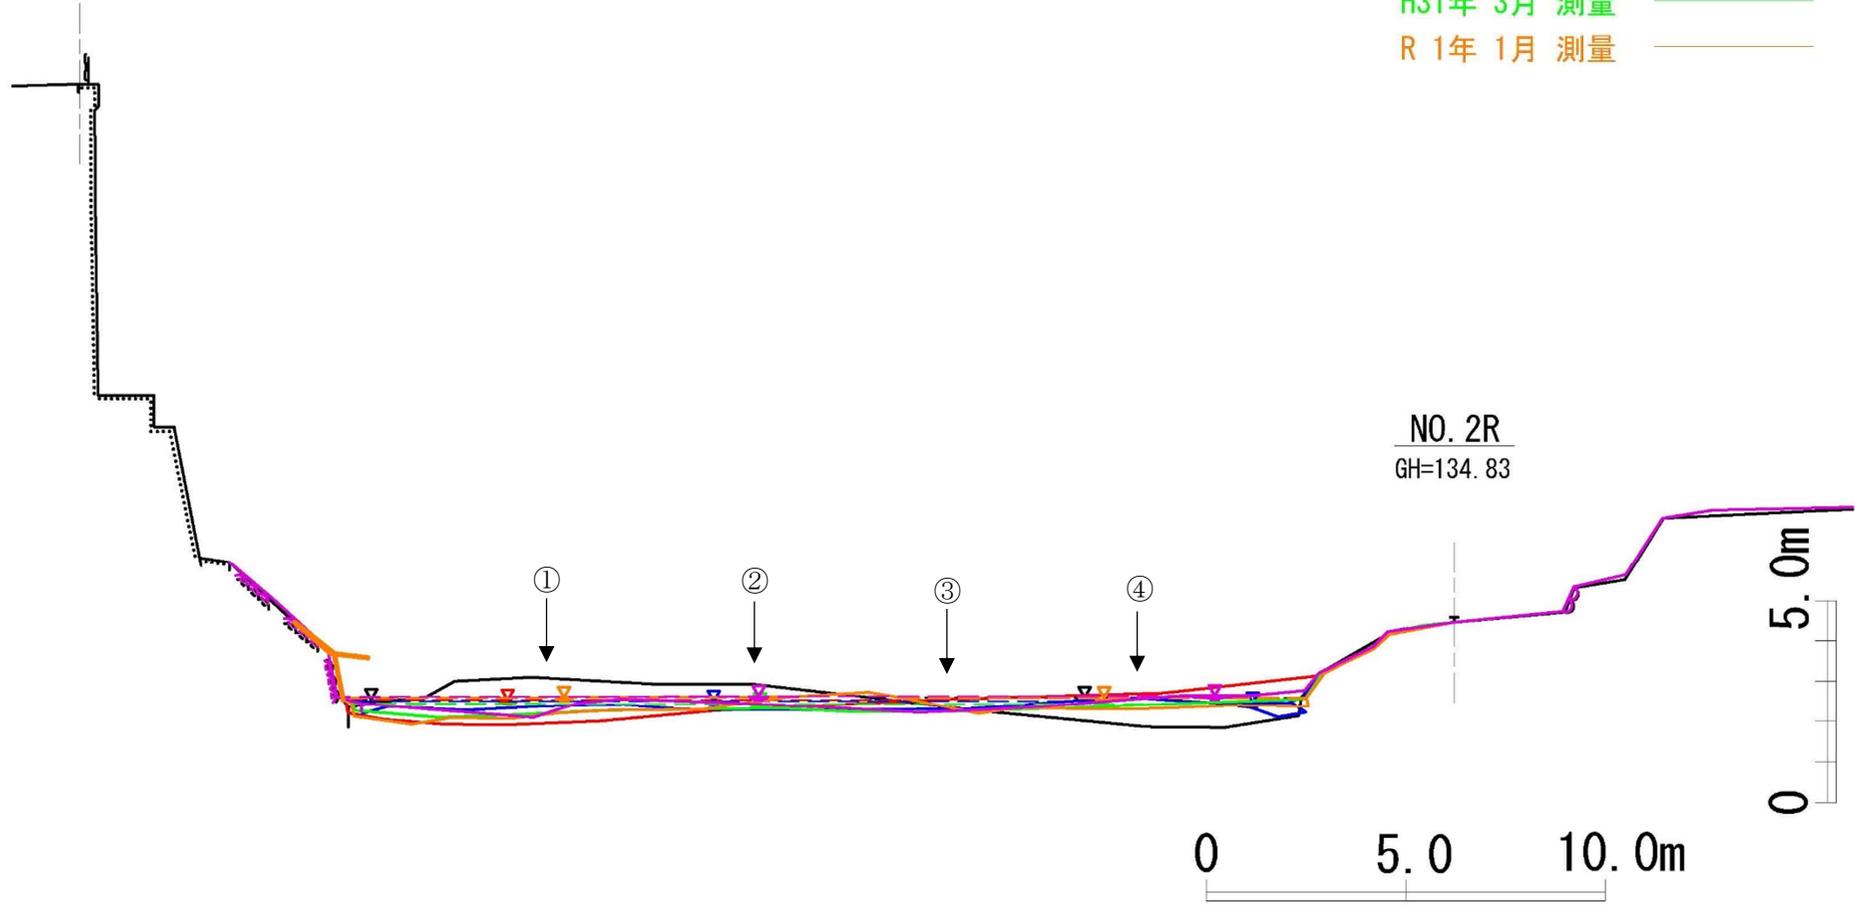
(2) 横断面图 (No. 2L, 2R)
